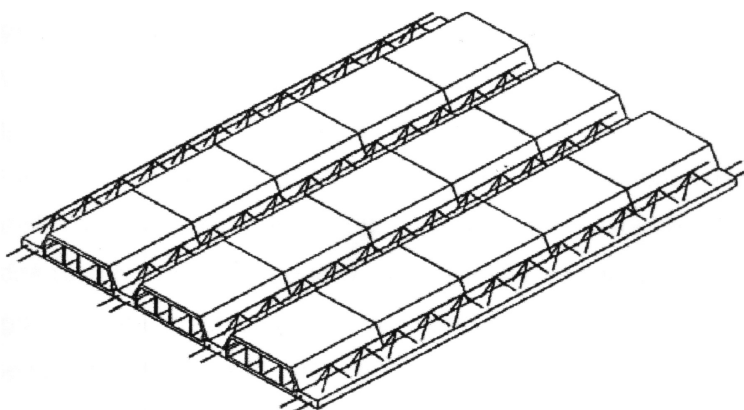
Laje pré-moldada com vigotas treliçadas (Silva Filho, 2002, p. 21).
